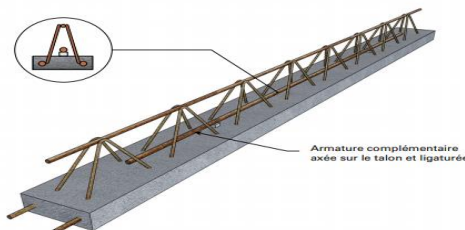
ARMATURE DE RENFORT DANS LE CAS DE POUTRELLES EN BA AVEC TREILLIS METALLIQUE
